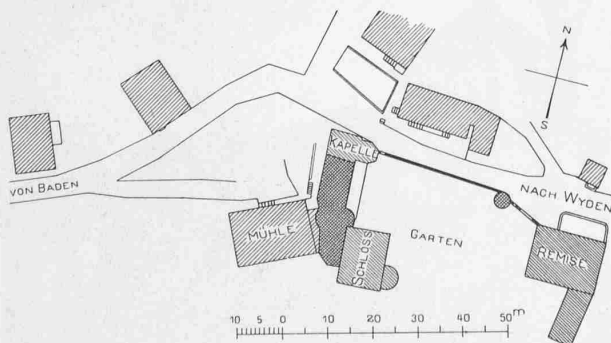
Lageplan des Schlösschens Bellikon. — Masstab 1:1500.
